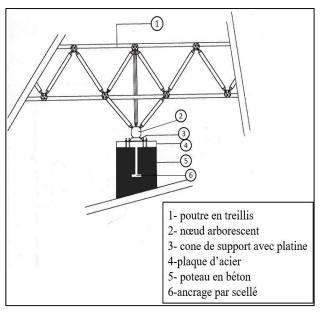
Détail d'assemblage poutre en treillis/ poteau en béton. Source :
